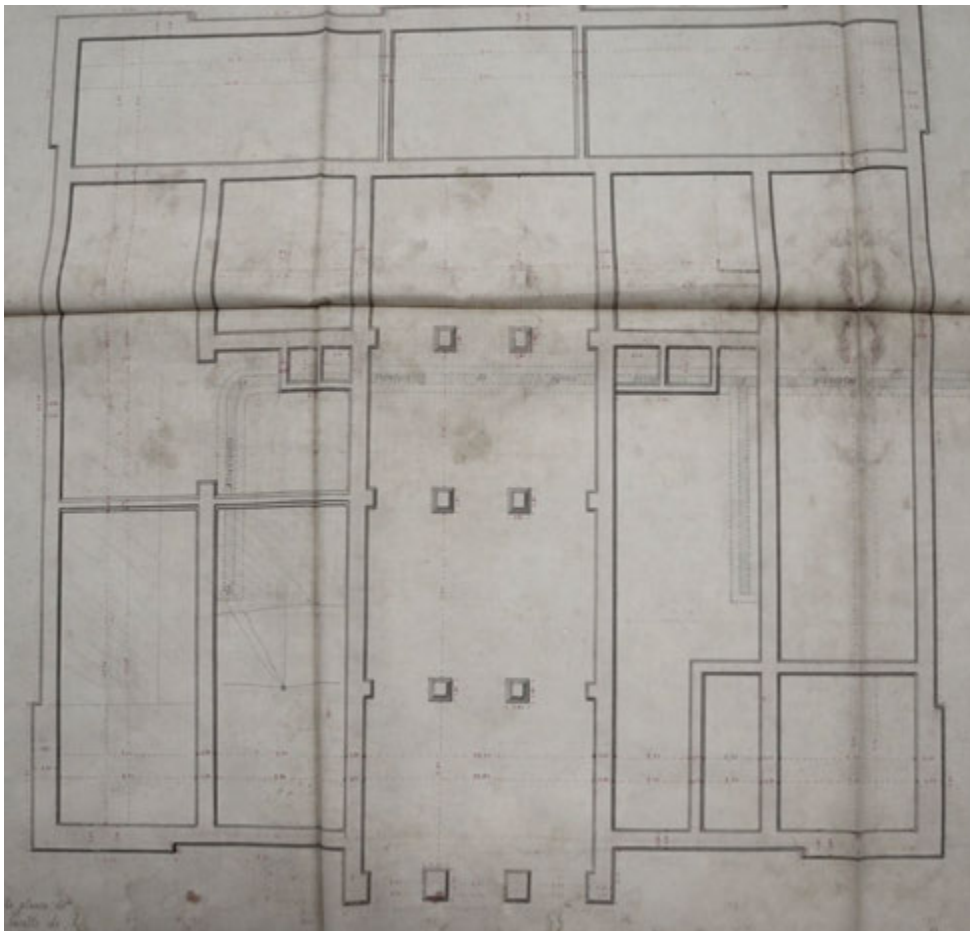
Planta de cimentaciones. Fotografía del autor.
